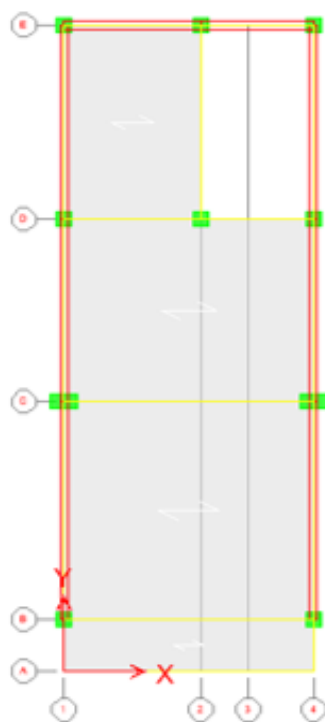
Vista en planta del modelo estructural segundo nivel
